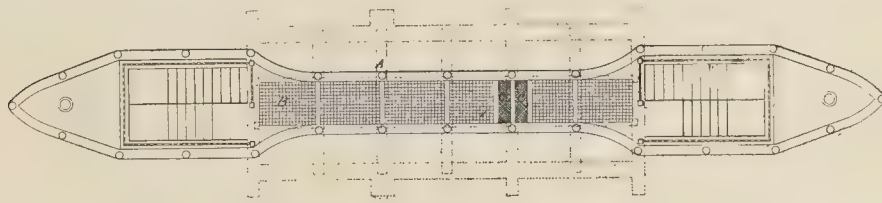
Wellington street (strand) (plan du sous-sol).
